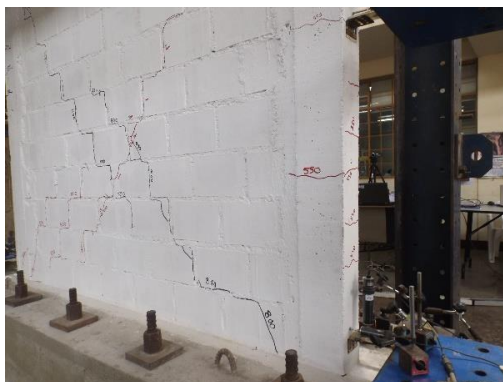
Aparición de grietas por flexión en la parte media e inferior de la columna Este para una distorsión de 1/550.
